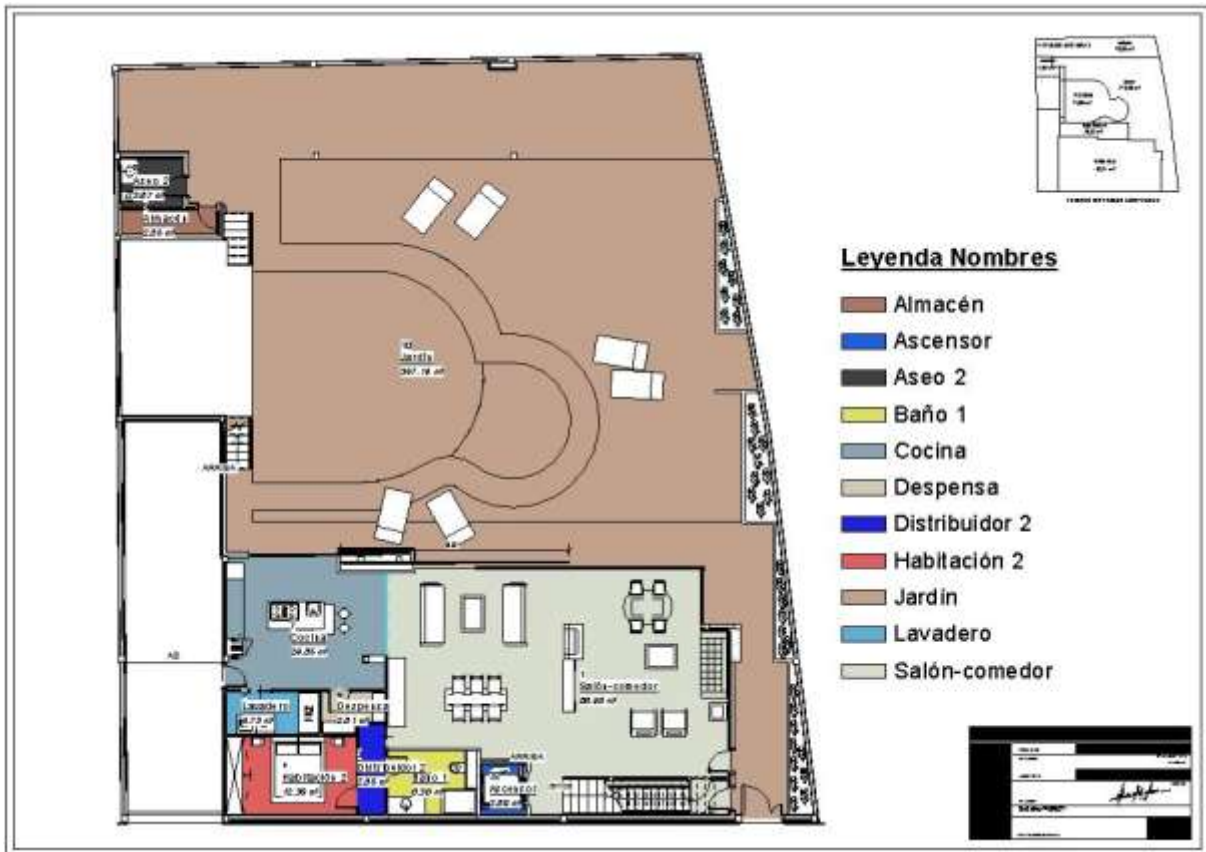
Plano de Superficies. Planta Baja. Fuente propia. 2016
